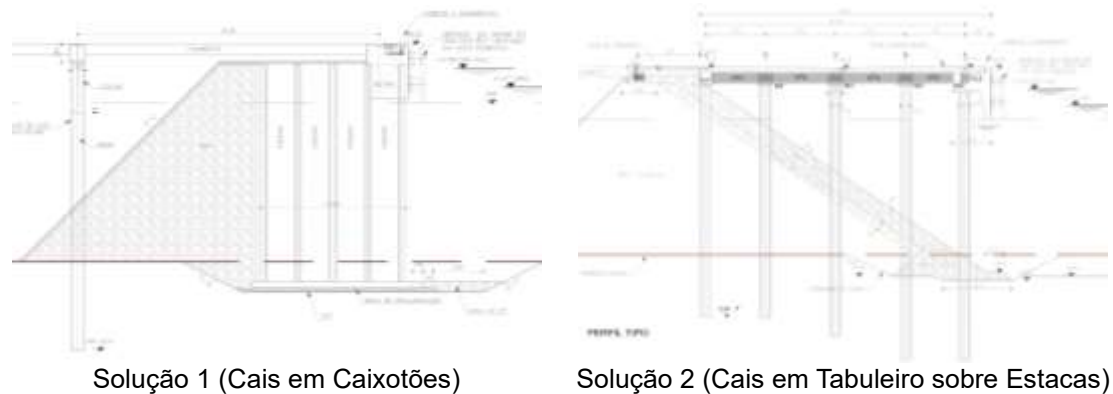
Alternativas a estrutura do cais de expansão do TCN
